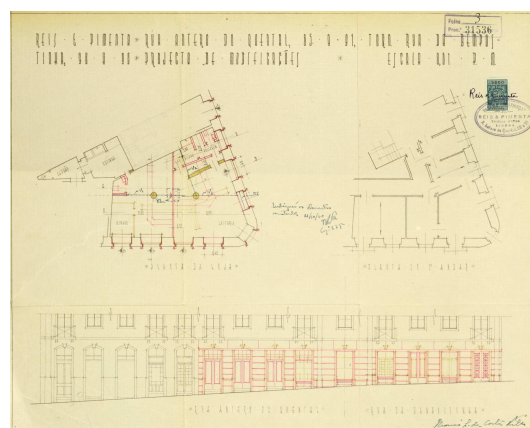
Planos iniciales presentados para la adaptación de la vaquería en tienda de vinos
